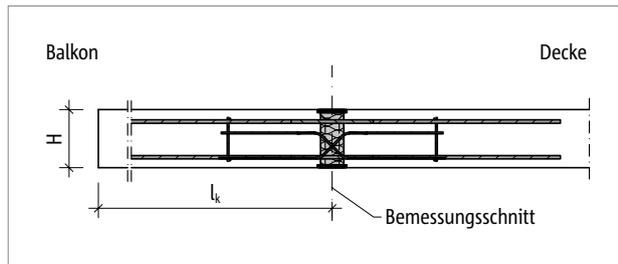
Schöck Isokorb® T Typ D: Statisches System
